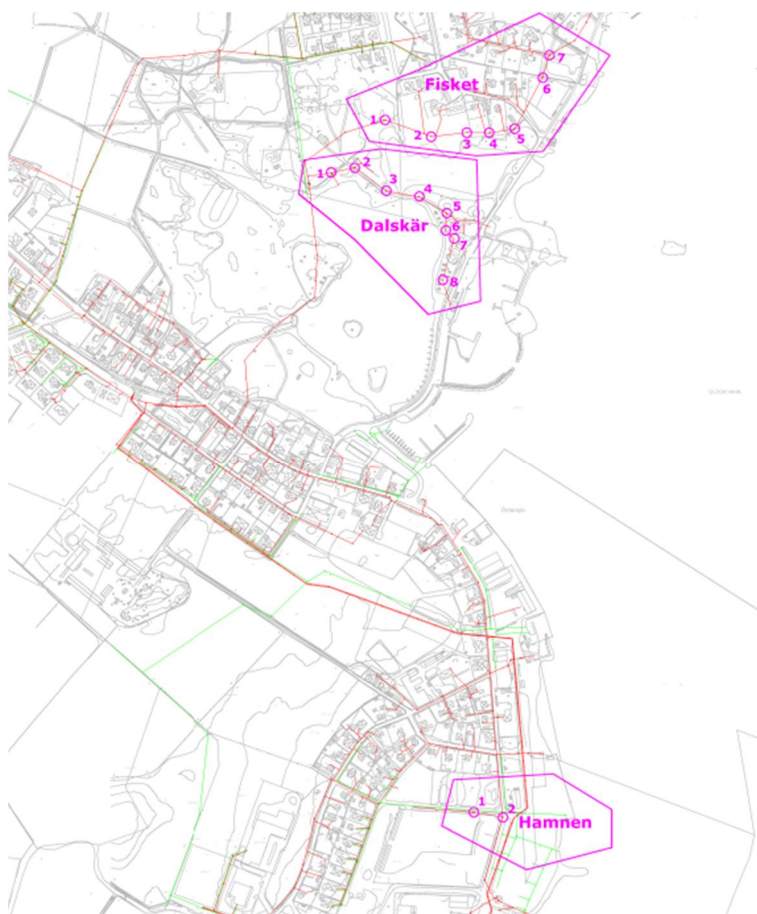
Plan – brunnar som bör besiktas okulärt med avseende på grundvatteninläckage, Bilaga 10
